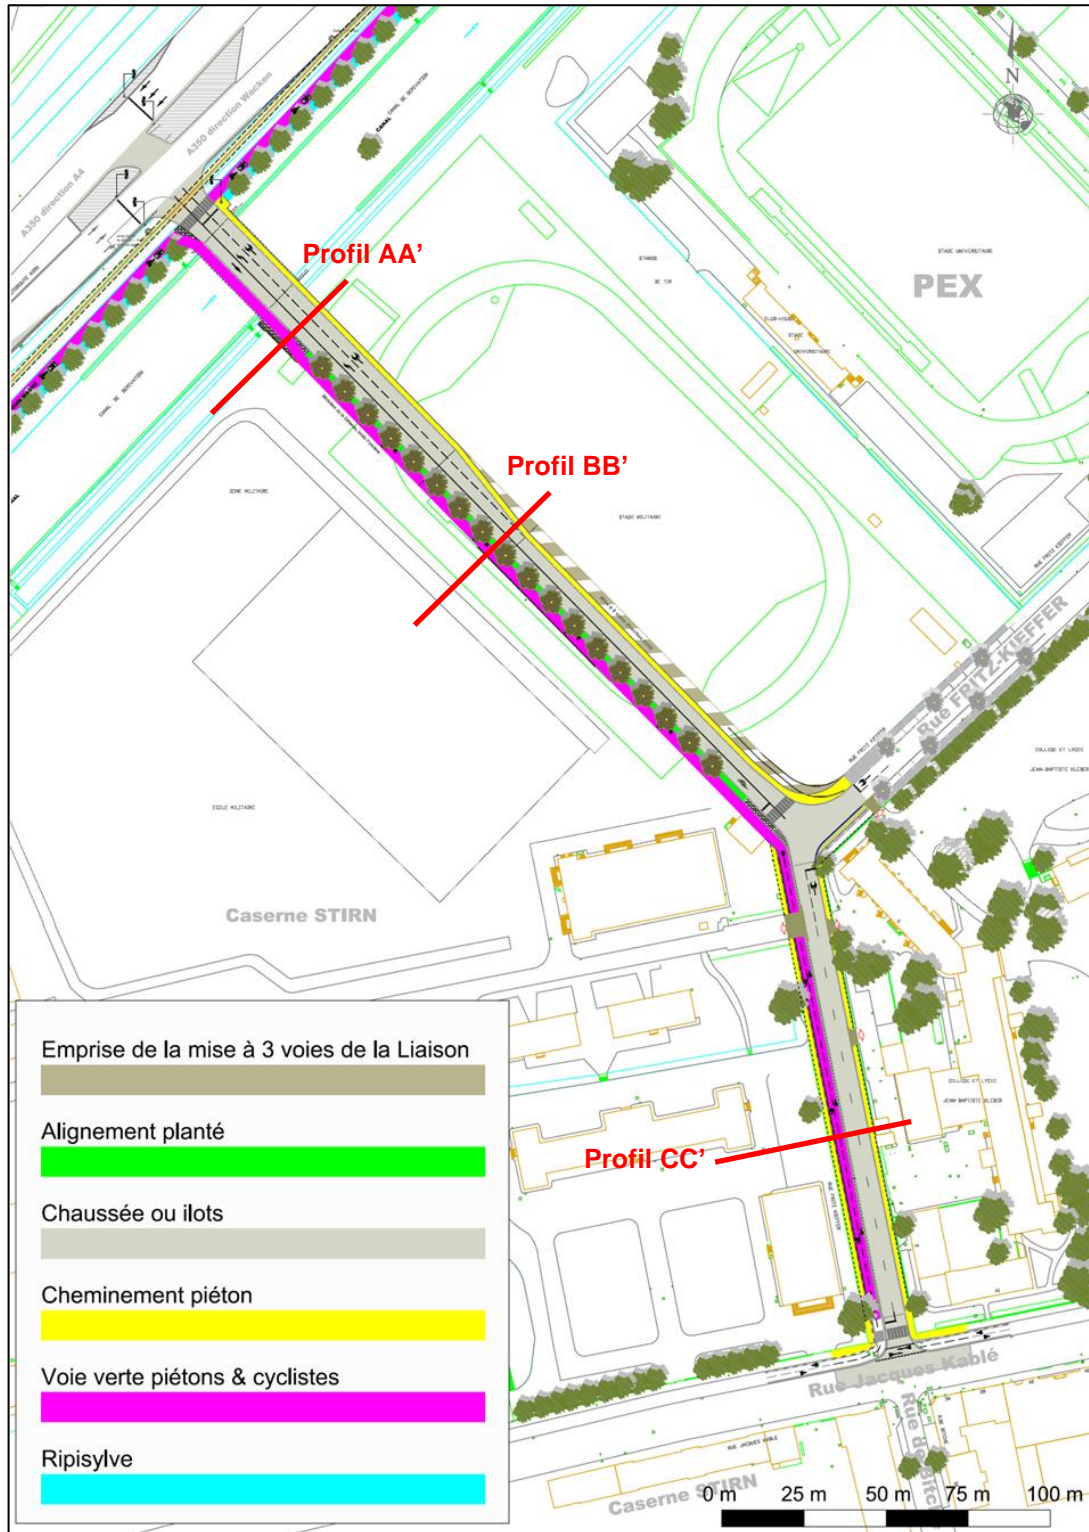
Plan AVP du projet de liaison routière (février 2014)
